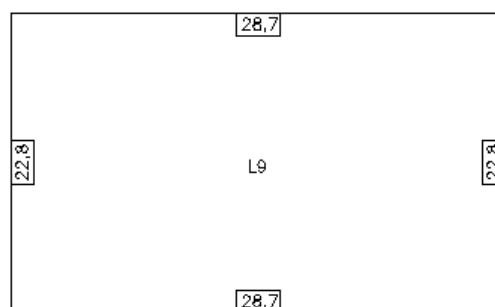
[b] – Reações da laje L9 sobre as paredes estruturais
